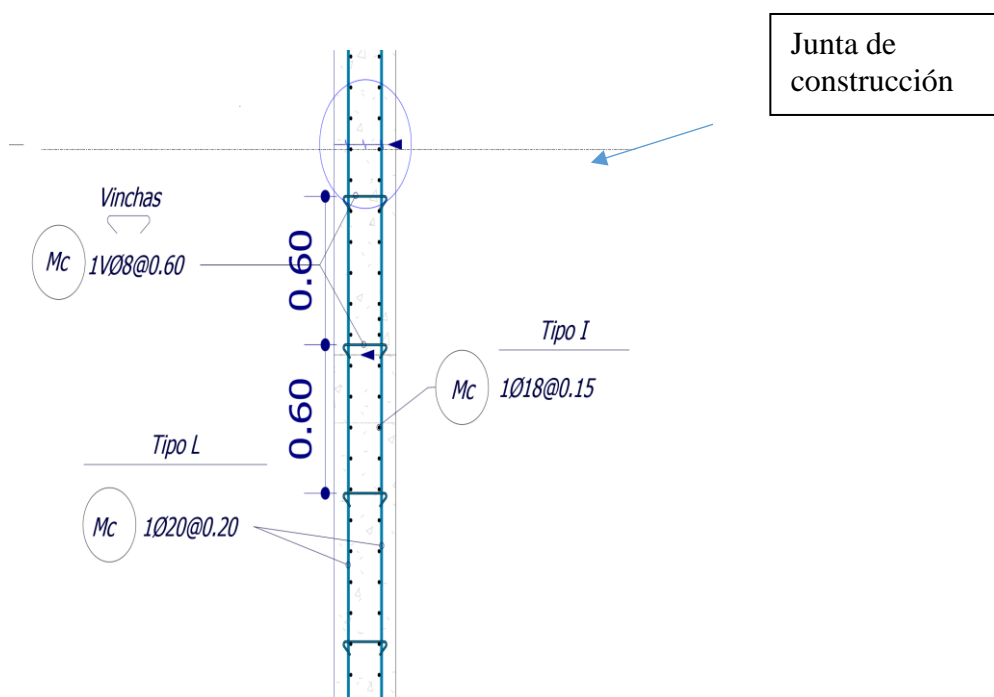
Detalle de reforzamiento estructural muro tipo.
